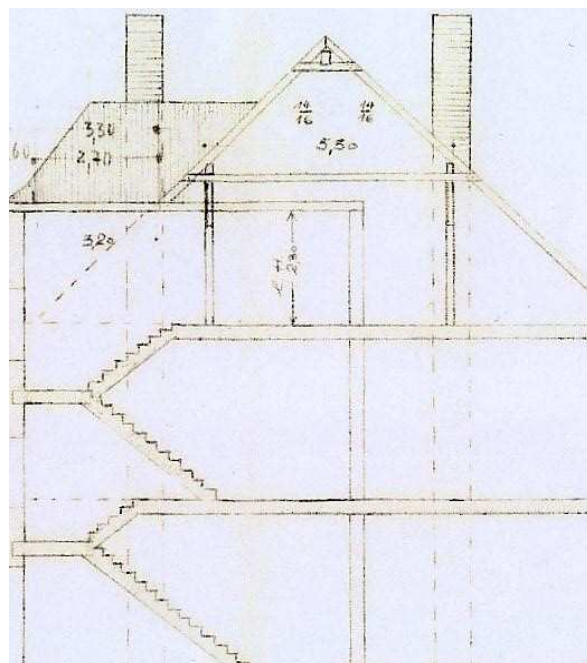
M.1 Schnitt, Ausschnitt Umbauplan (undatiert)
